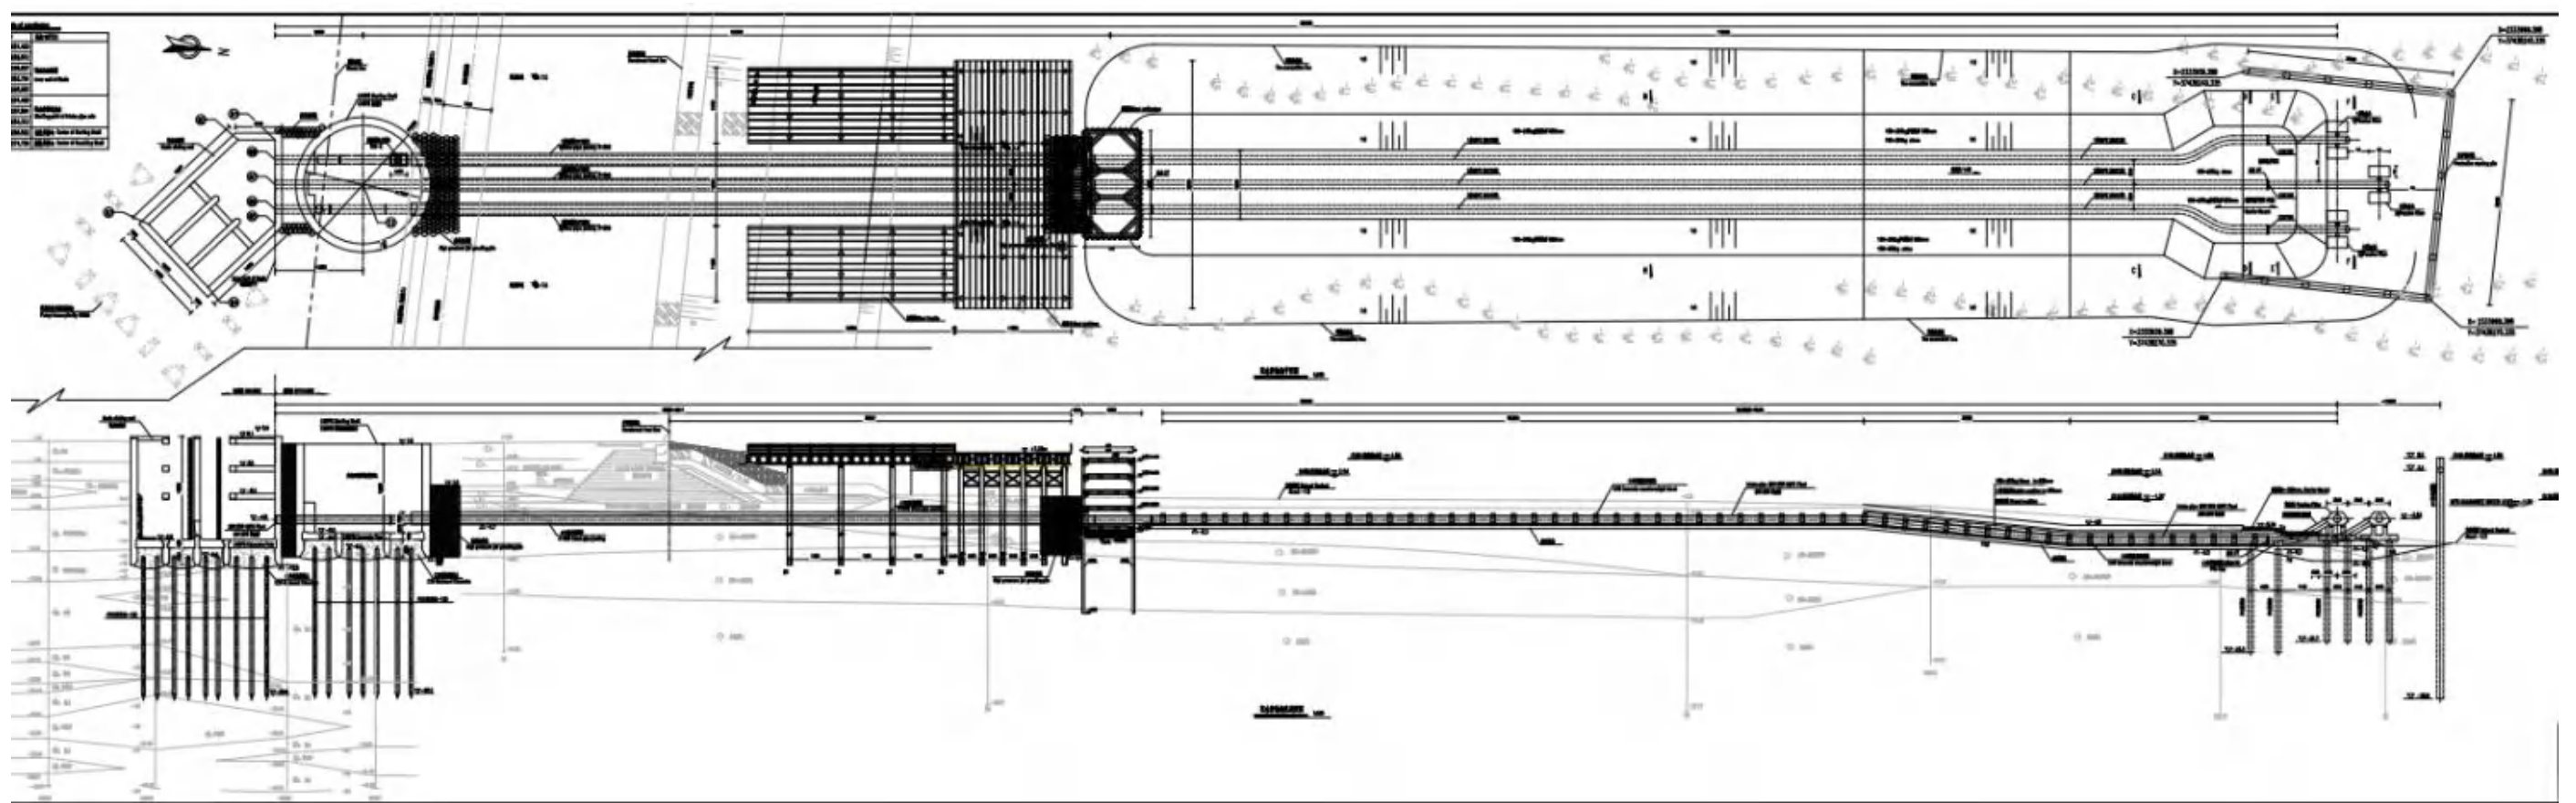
取水管结构平立面图（钢板桩施工期）
